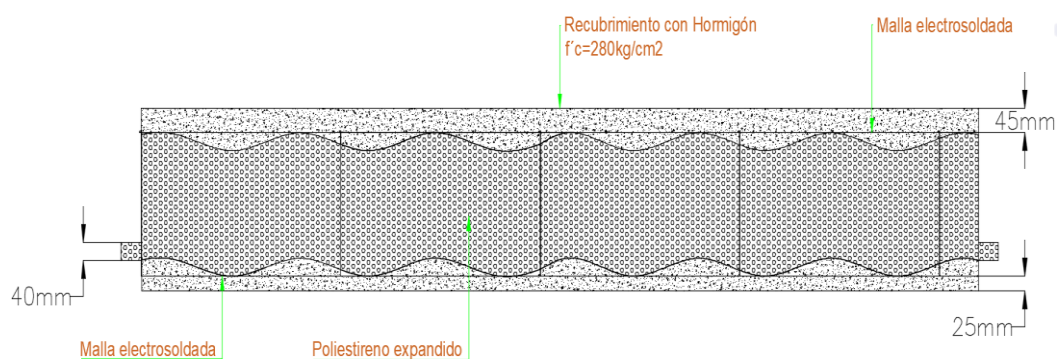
Sección típica Panel Losa estructural 1 nervadura
